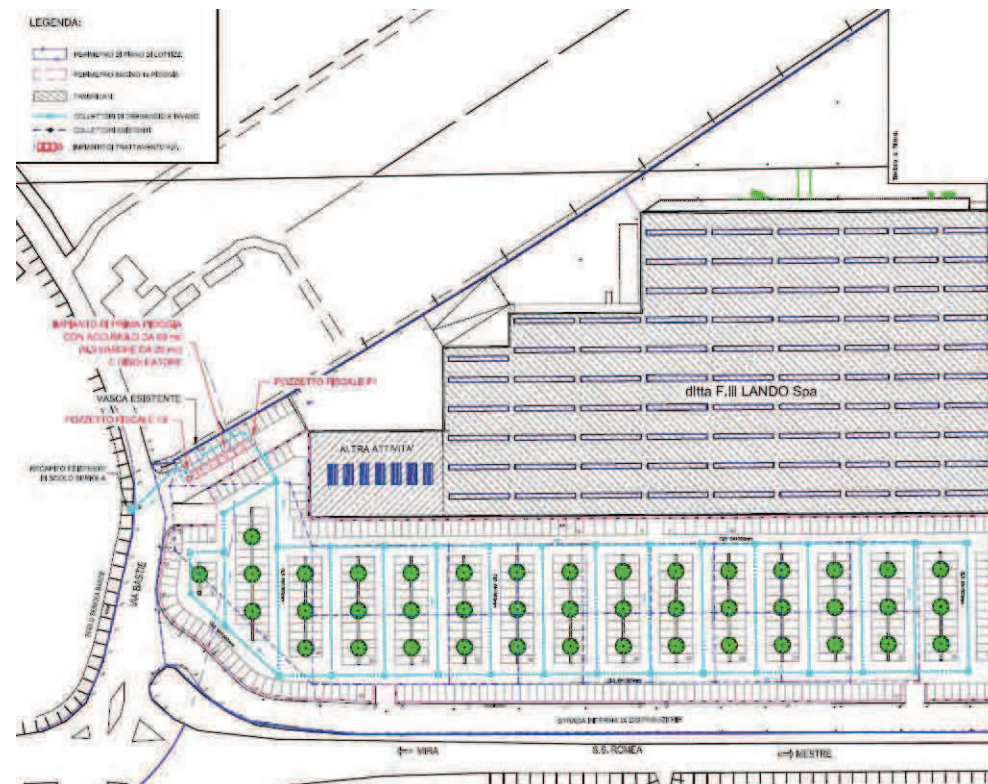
Estratto Tav. 02 progetto rete acque meteoriche
